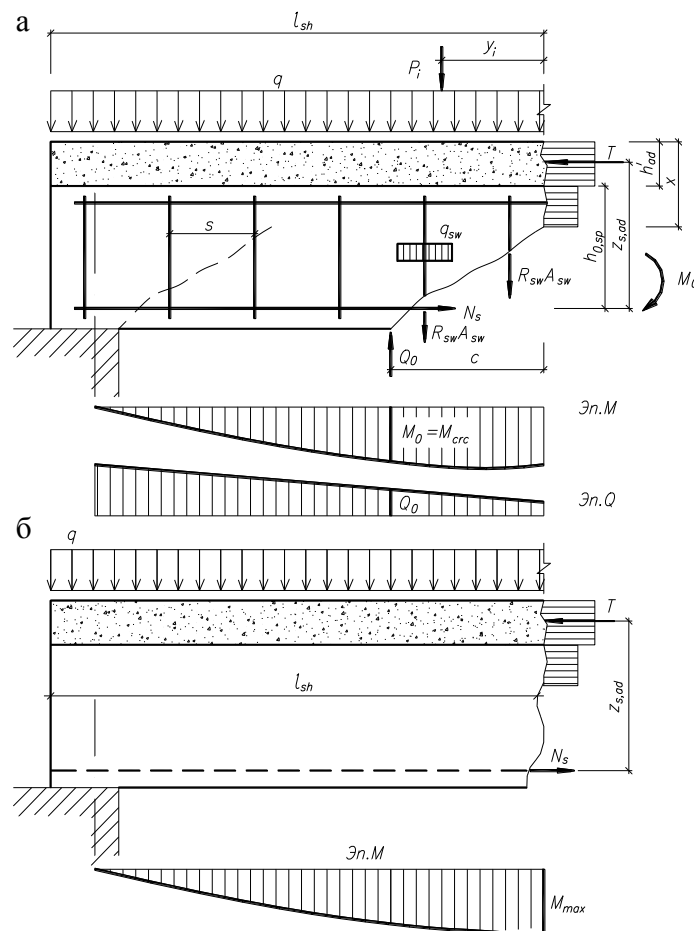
Схема для определения усилий и расчетной длины контактного шва у свободной опоры:
